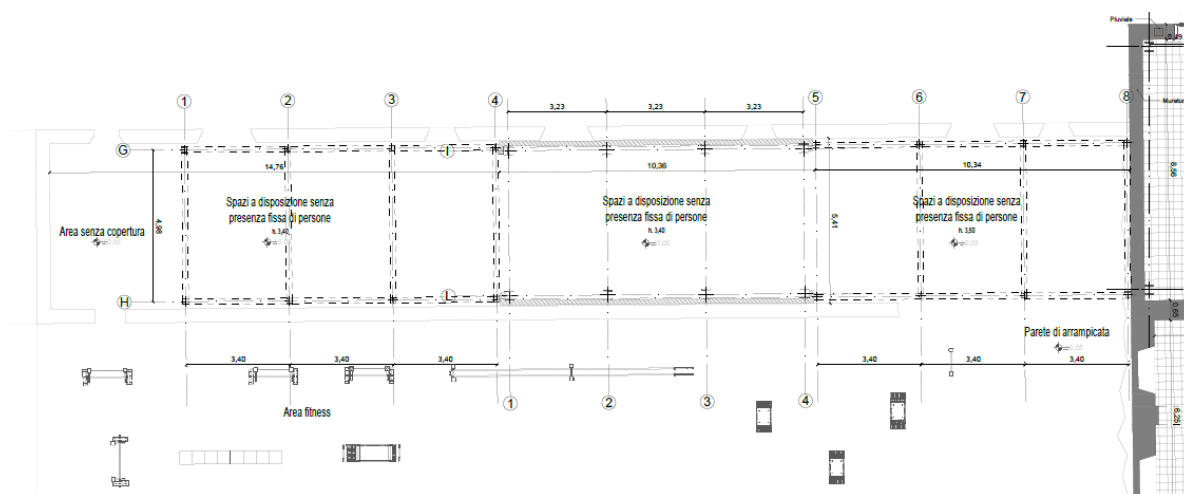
Ex-Galoppatoio - pianta piano terra Edificio 3
